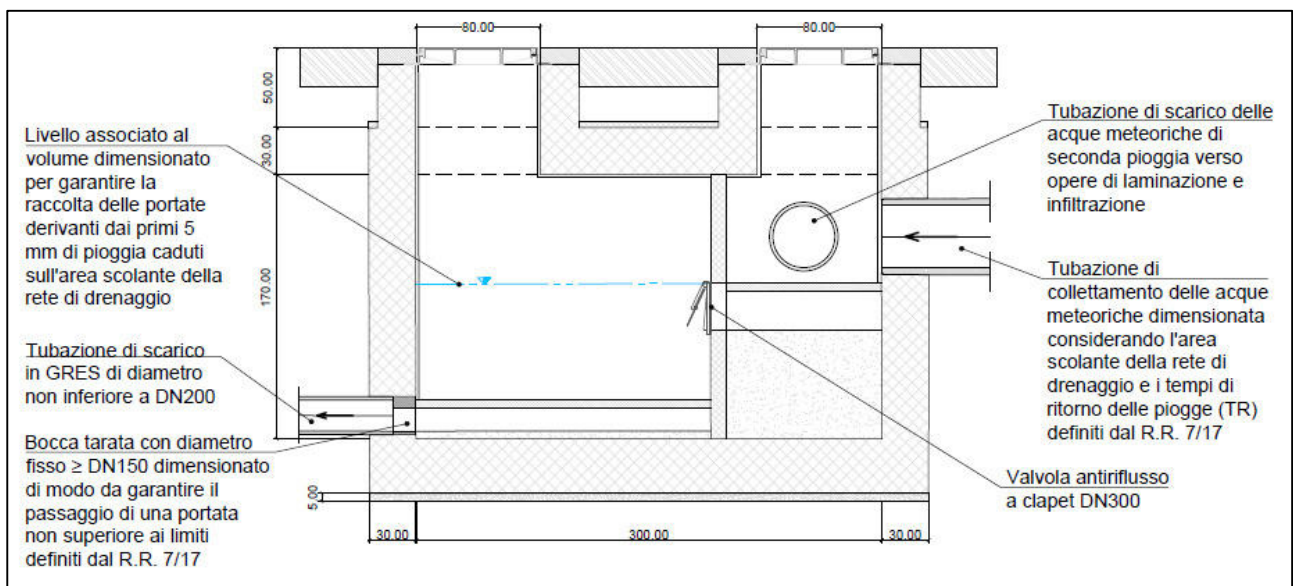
Manufatto di scarico controllato delle acque meteoriche con sistema di separazione delle acque di prima e seconda pioggia da installare a monte delle opere di infiltrazione
